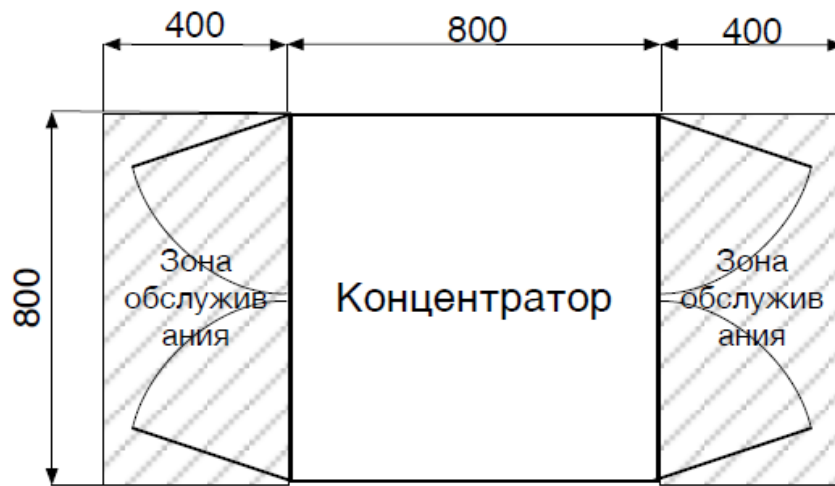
Внешний вид и габаритные размеры концентратора с одностворчатыми дверями
